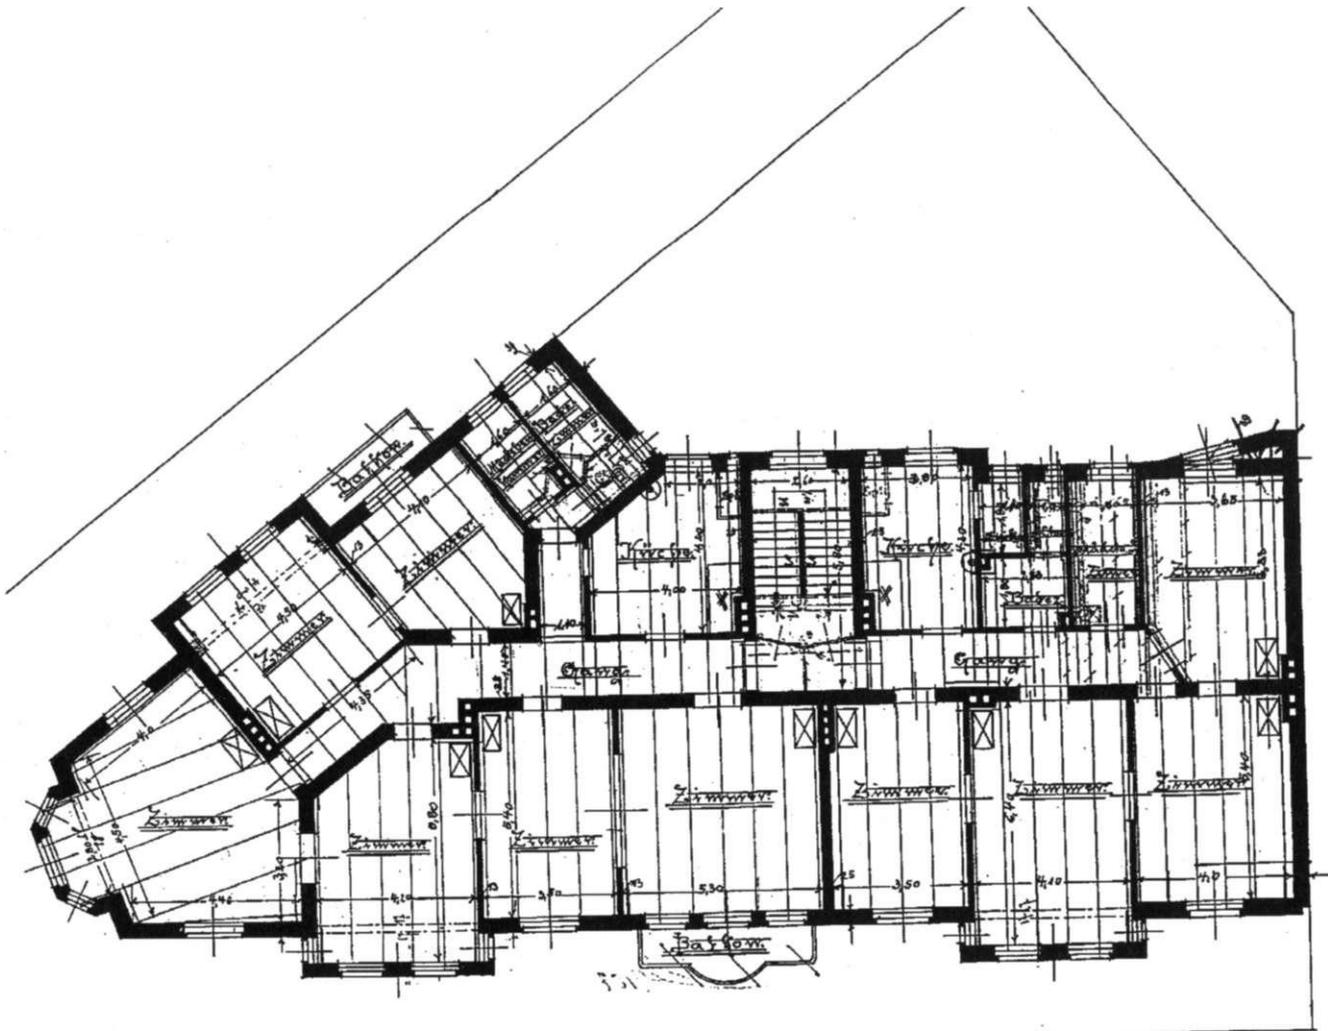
Adelheidring 17, Grundriß 1. und 2. Obergeschoß
